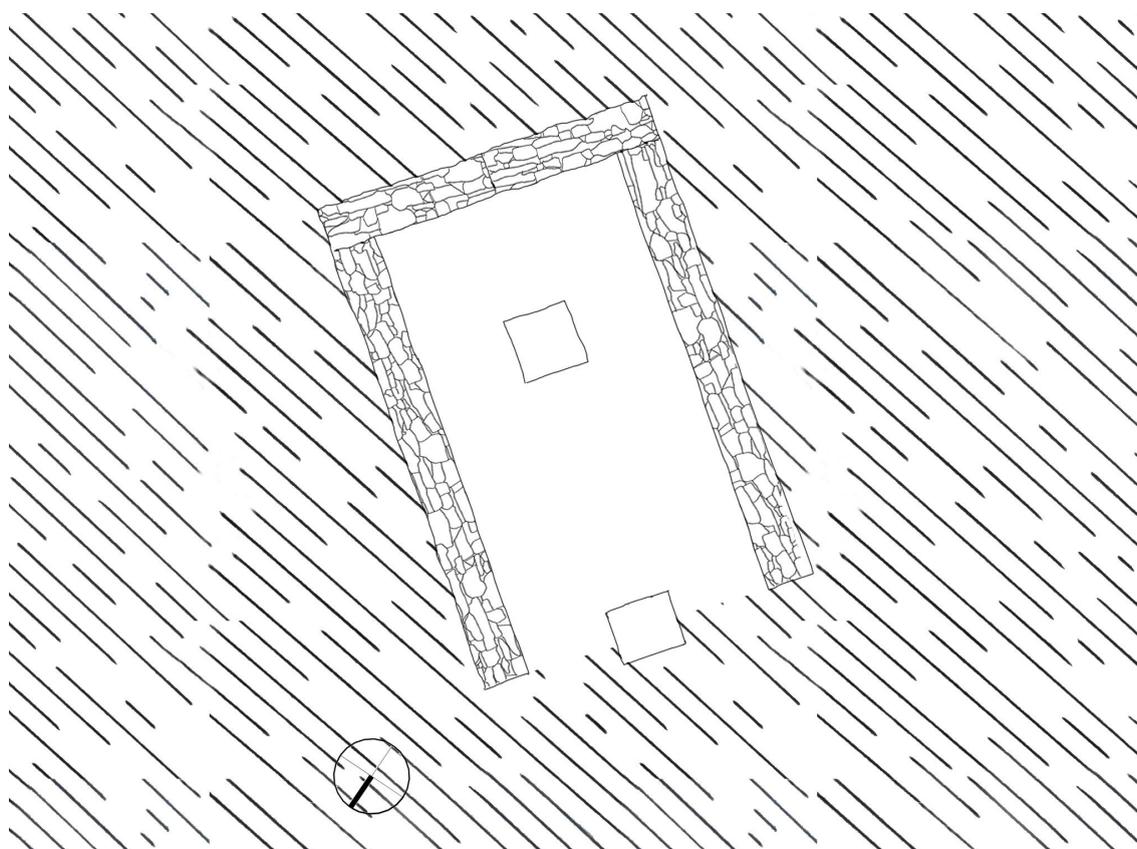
Andriani Mario. planimetria di rilievo sc. 1:100
